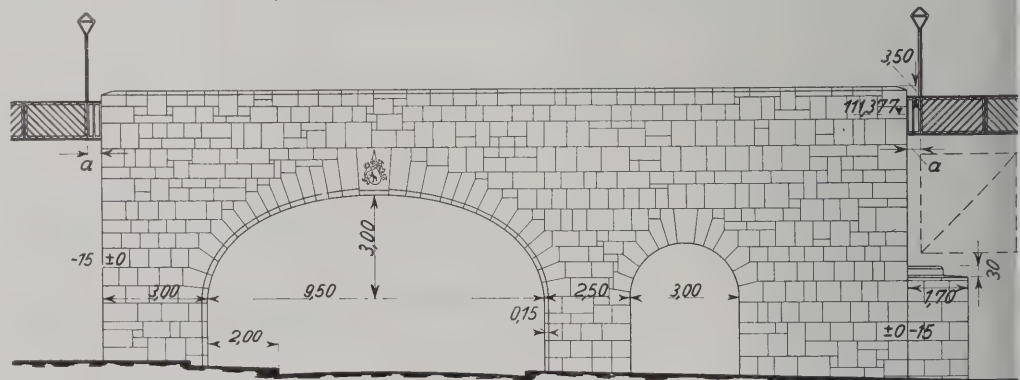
Erster Entwurf Tessenow für die Unterführung der Siebeneichener Straße.
